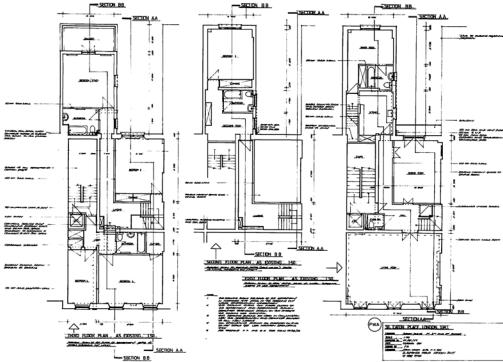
Plantas de la vivienda 59 Eaton Place en su estado anterior al proyecto realizado por Zaha Hadid.
